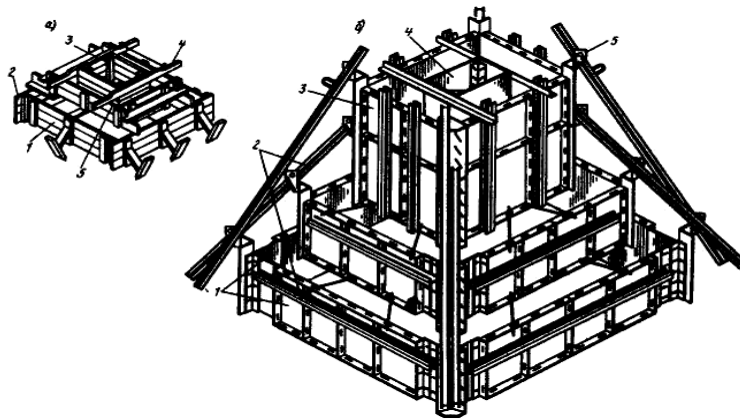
Щитова опалубка східчастих фундаментів стаканного типу під колони: а - з щитів на зшивних планках: 1 - заставний щит; 2 - накладний щит, 3 - опалубка-пустотообразователі; 4 - опорний брус, 5 - тяж (скручування), б - з інвентарних щитів: 1 - кутові щити опалубки; 2 - сутички, 3 - опалубка верхнього ступеня, 4 - стаканообразувач; 5 – прапорці
